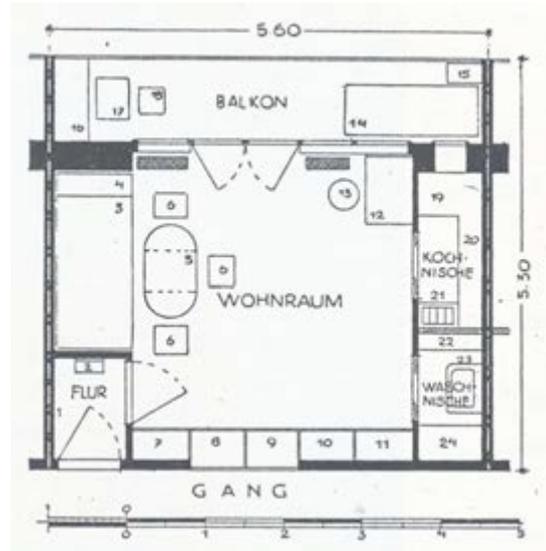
Margarete Schütte-Lihotzky, Grundriss der Einzimmerwohnung für die berufstätige Frau Typ 3, 1928.
